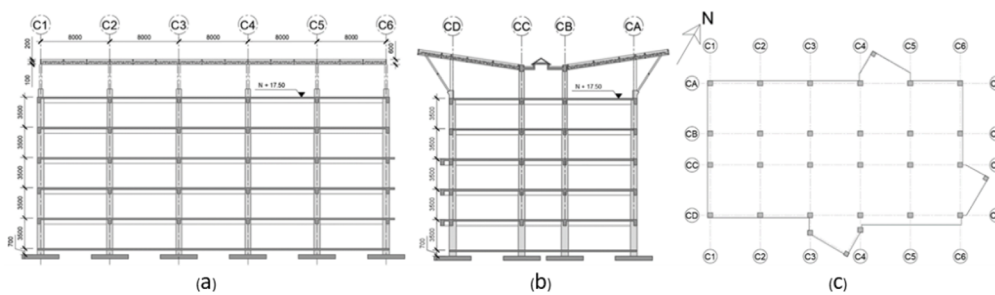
(a) Corte longitudinal esquemático (b) Corte transversal esquemático (c) Esquema de planta estructural
